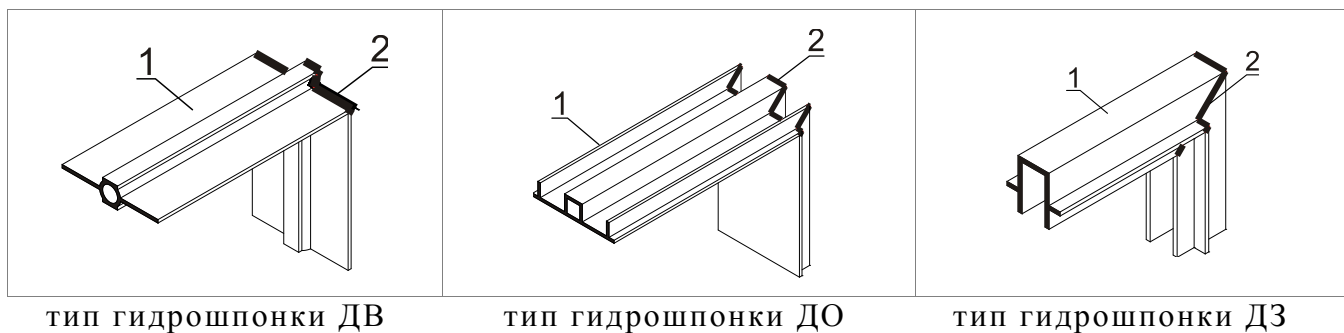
Поворот вертикальный внешний: 1-шпонка; 2-сварной шов
